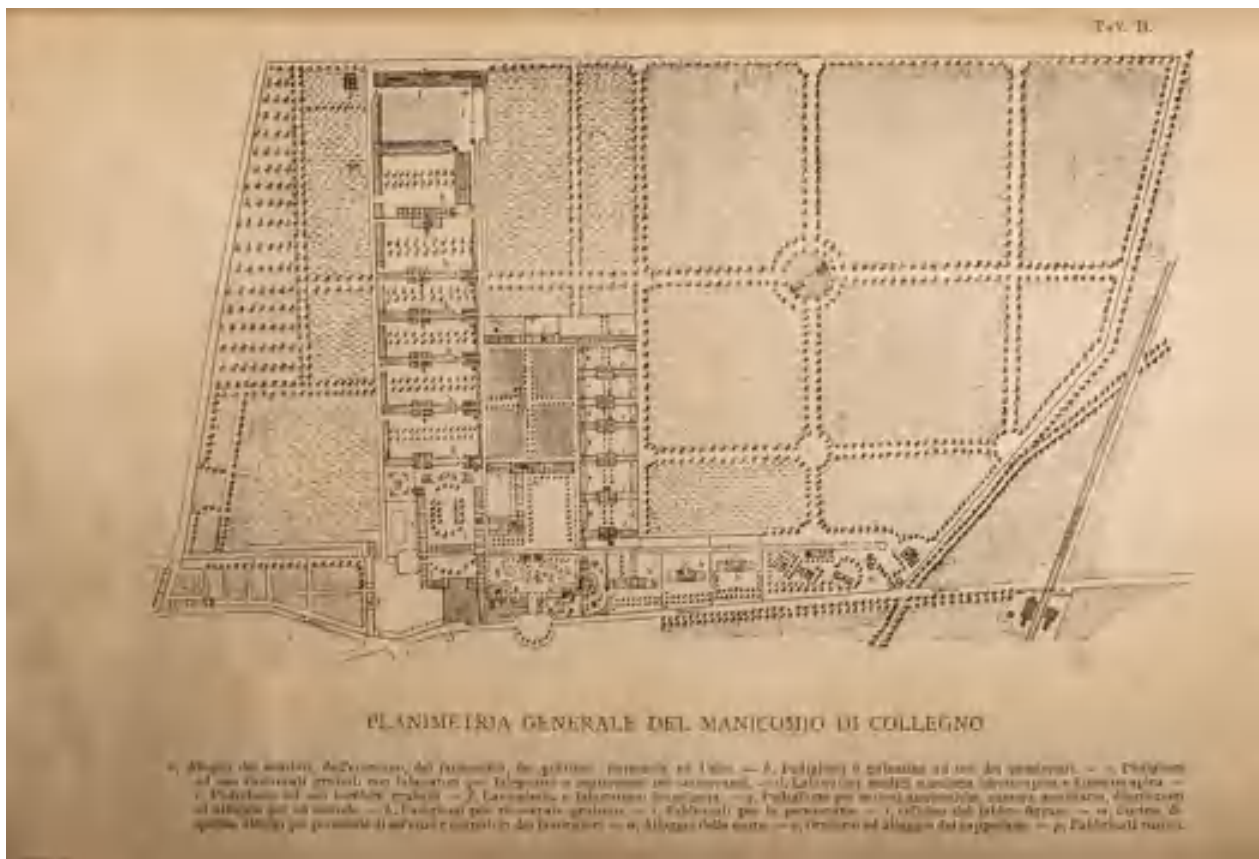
Planimetria generale del manicomio di Collegno (FENOGLIO 1902).
